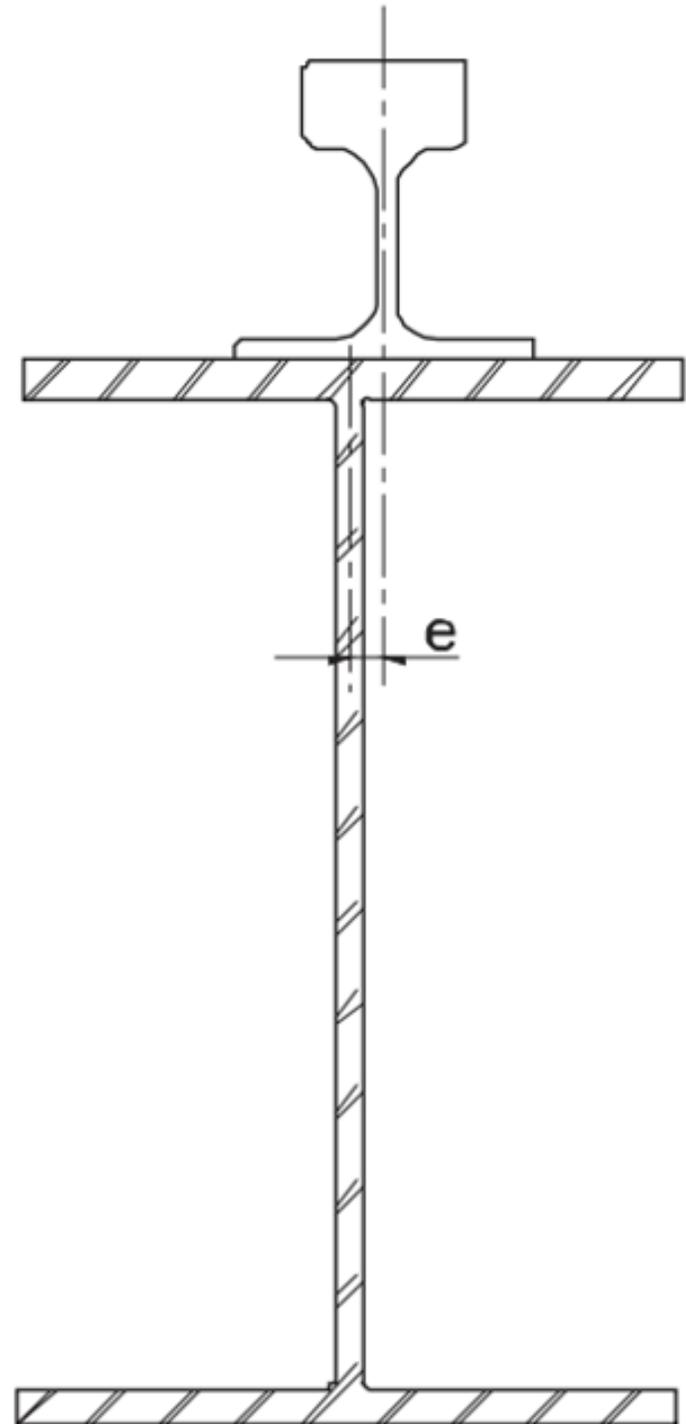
, Excentricité rail-poutre, d'après AISC DG 7
